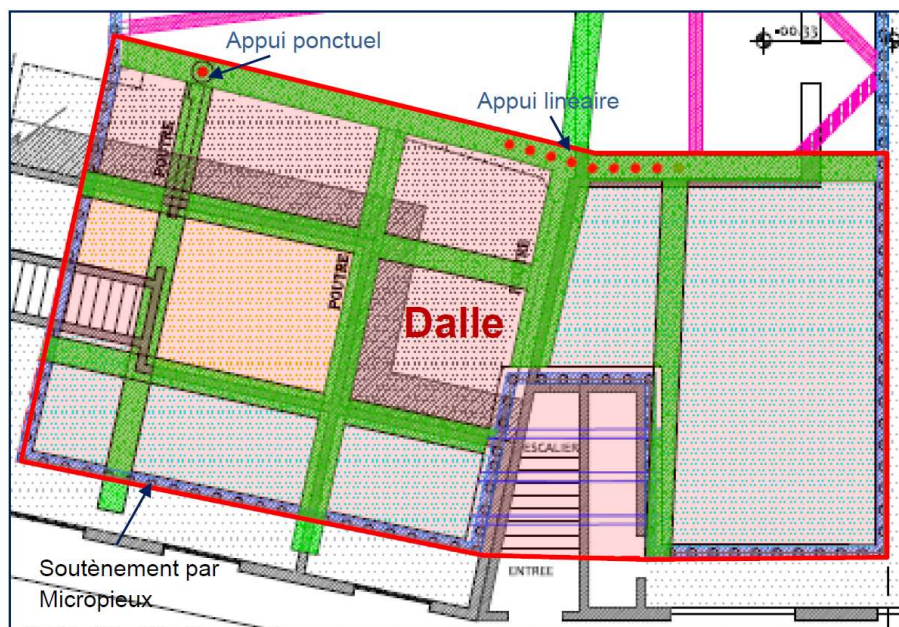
Cas test TPL-32201 – Vue en plan de la dalle
